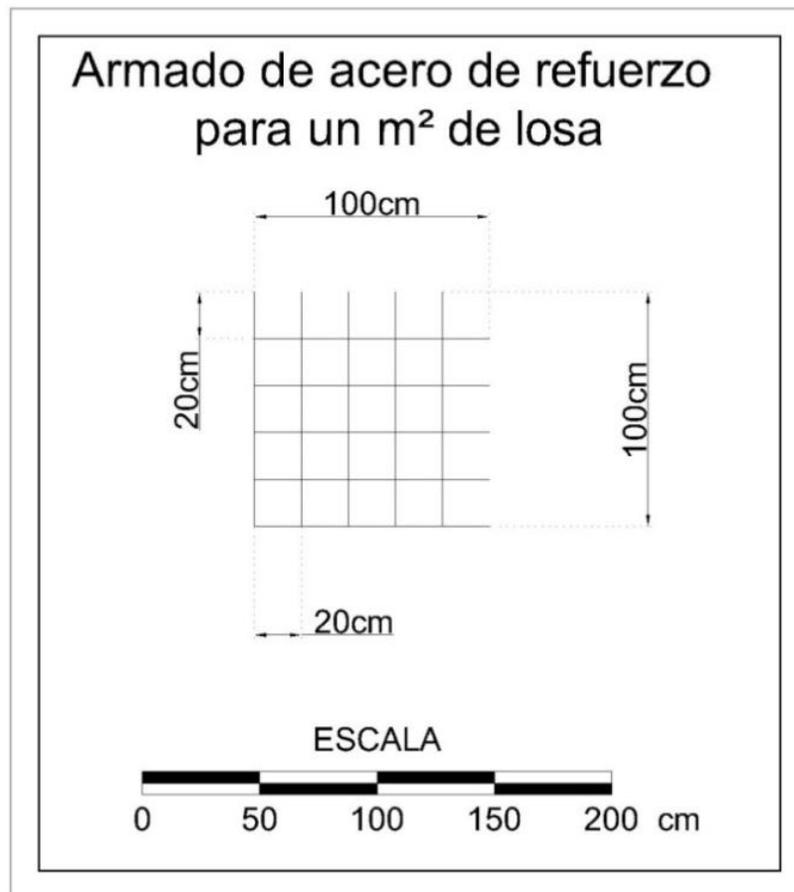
Armado de Acero de refuerzo para un m^2 de losa.
